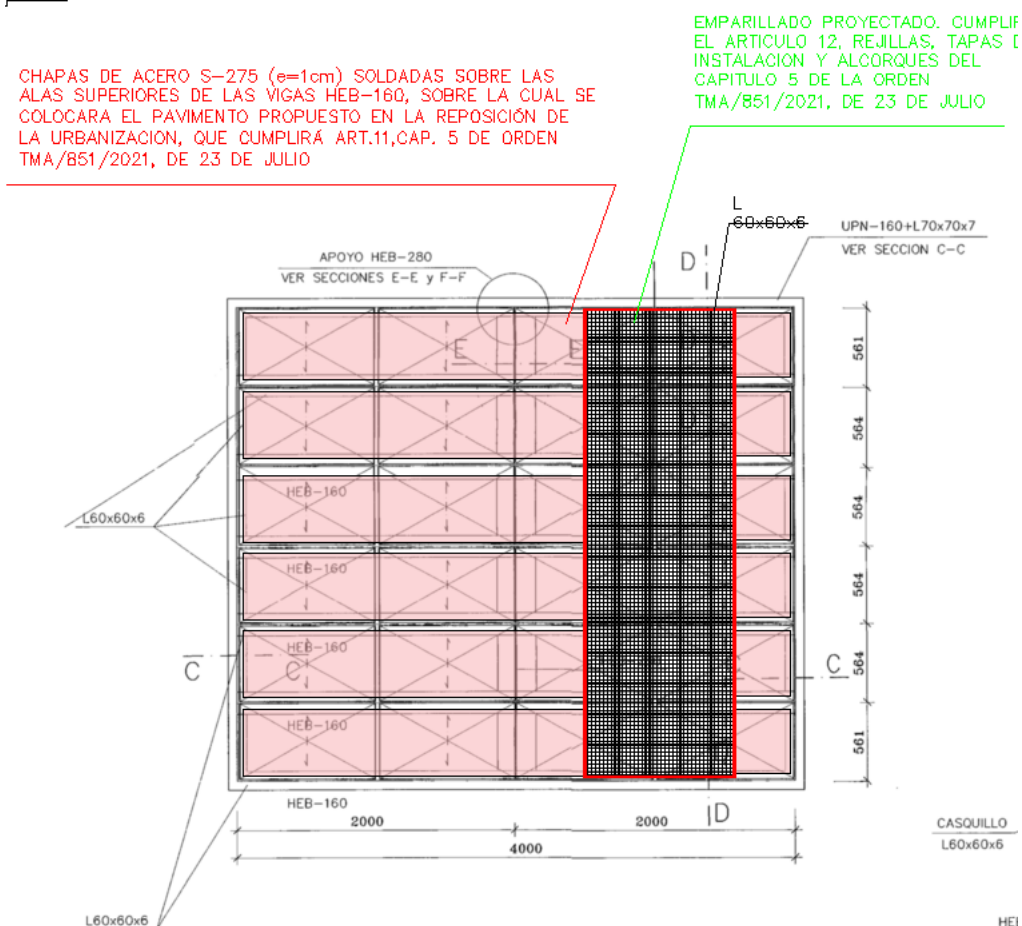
Actuación cierre rejilla de ventilación c/ Barquillo – Vista en planta
